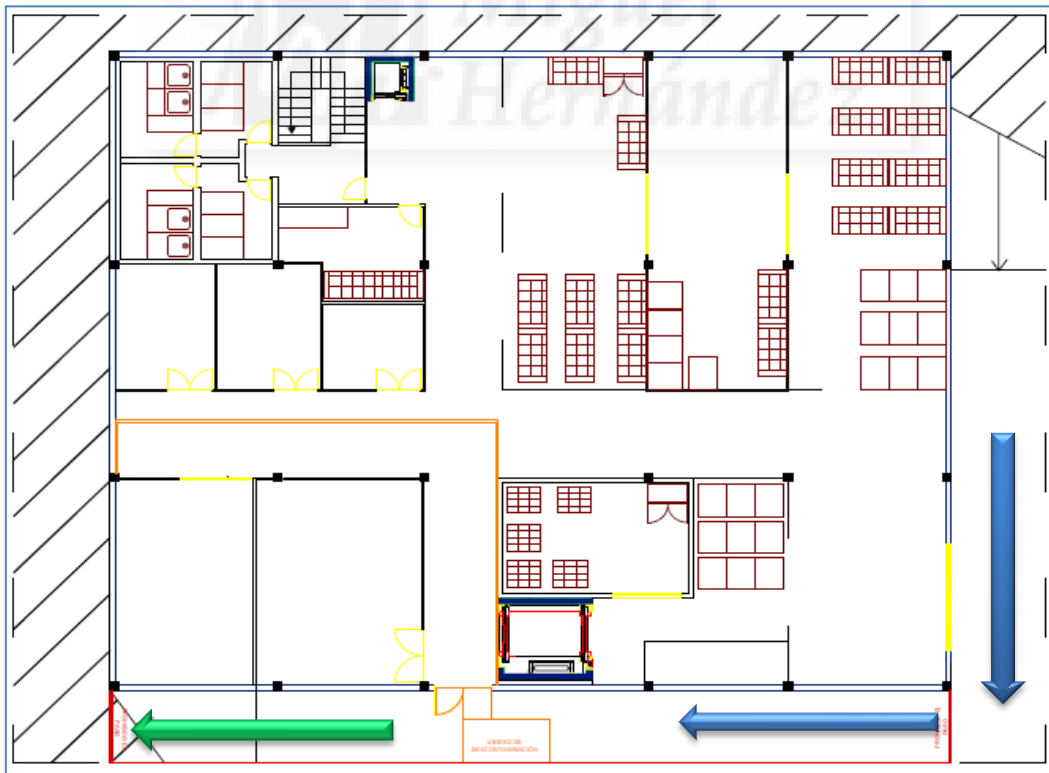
21. Plano zonas de acceso y salida de trabajadores y residuos.
